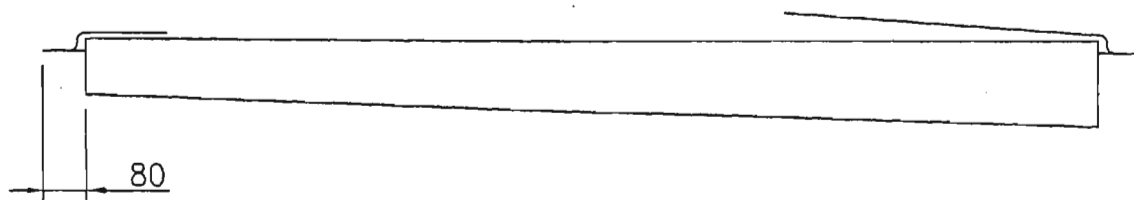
Эскиз типовой железобетонной стойки для опор ВЛ 0,4-10 кВ.
